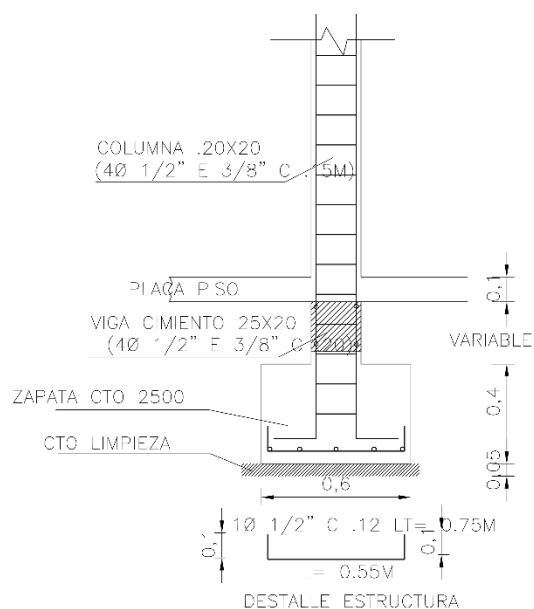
archivos Planeación Municipal de Honda Tolima (2019) Detalle zapata.
